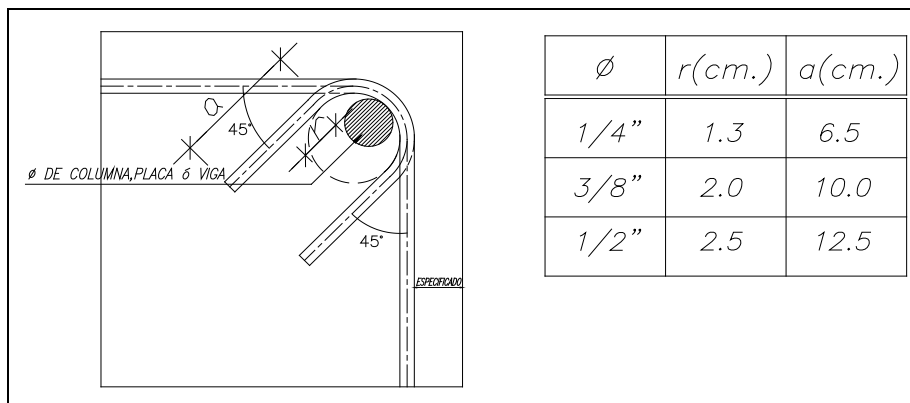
Detalle de doblado de estribos en columnas y vigas
